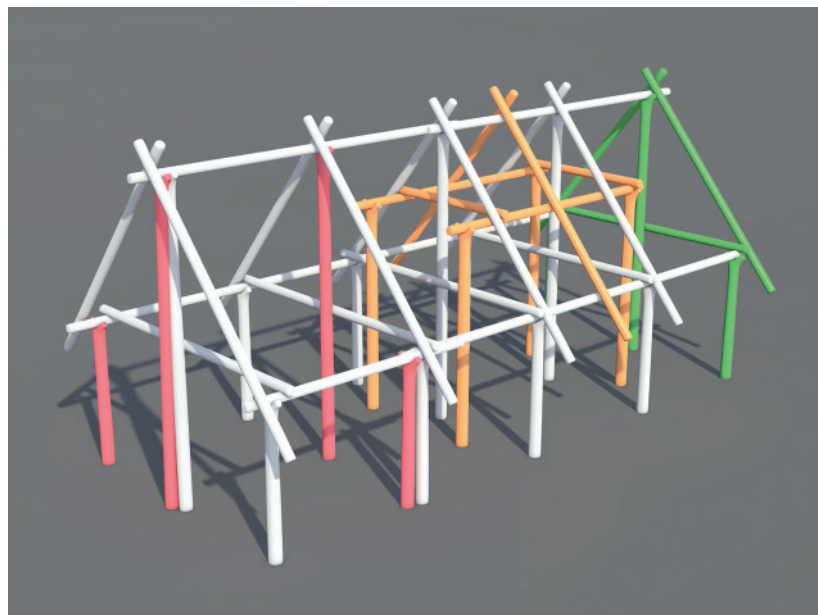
Hausrekonstruktion bei ebenerdiger Bauweise. Die Pfähle, das heisst die vertikalen Konstruktionen eines Gebäudes, umfassen den Grundbau (weiss, First- und Wandpfosten) und datieren den Bau des Hauses. Die nachträglichen Ausbesserungen und Unterhaltsarbeiten umfassen Zusatz- und Ersatzpfosten (rot), neue Gebäudejoche (grün) und zusätzliche Stützen eines Zwischenbodens oder des Daches selbst (orange). Ihre Datierungen ergeben die (minimale) Nutzungsdauer der Struktur. Die aufgehenden Rekonstruktionen dieser Darstellung sind frei erfunden.
